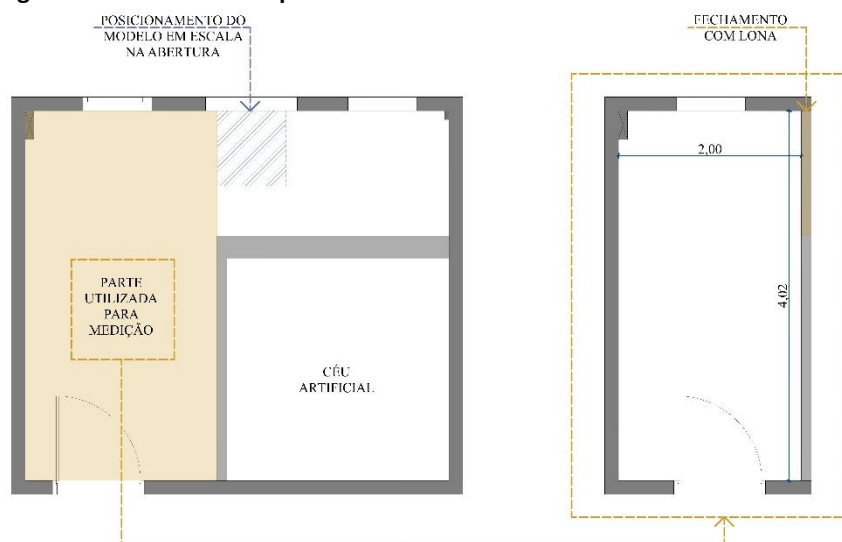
Planta baixa do quinto pavimento do prédio de Arquitetura e Urbanismo
